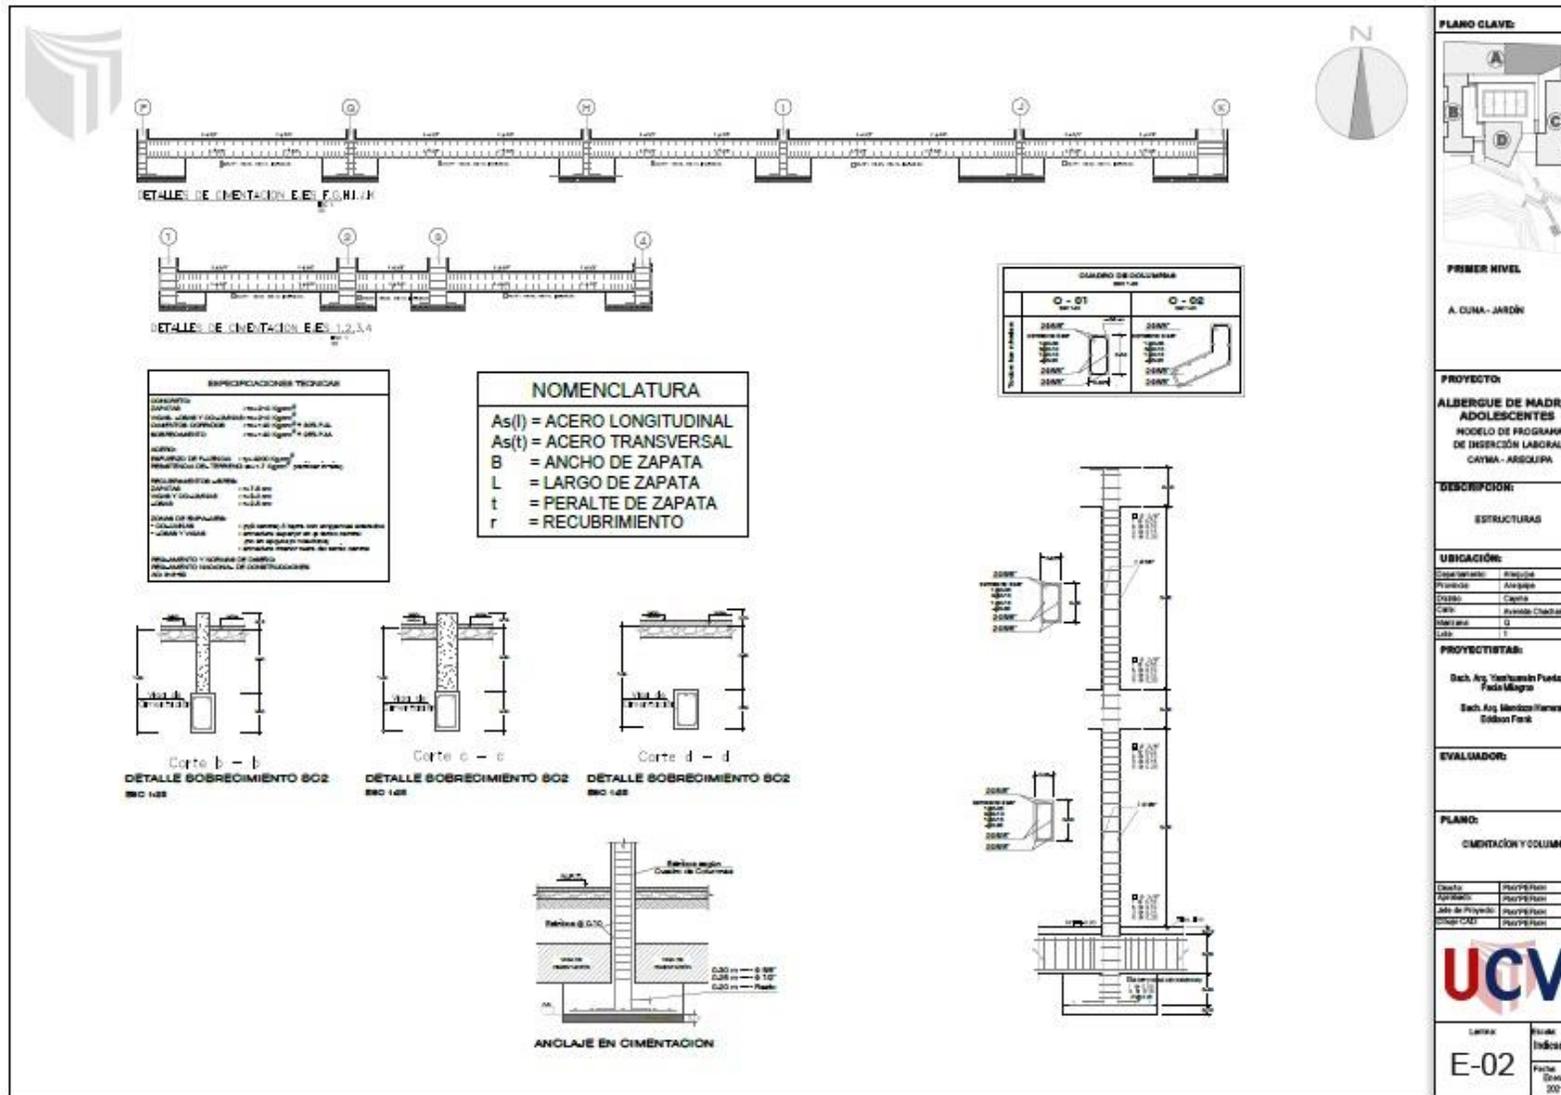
Plano de Cimentación – Sector A – Cuna Jardín E-02.
